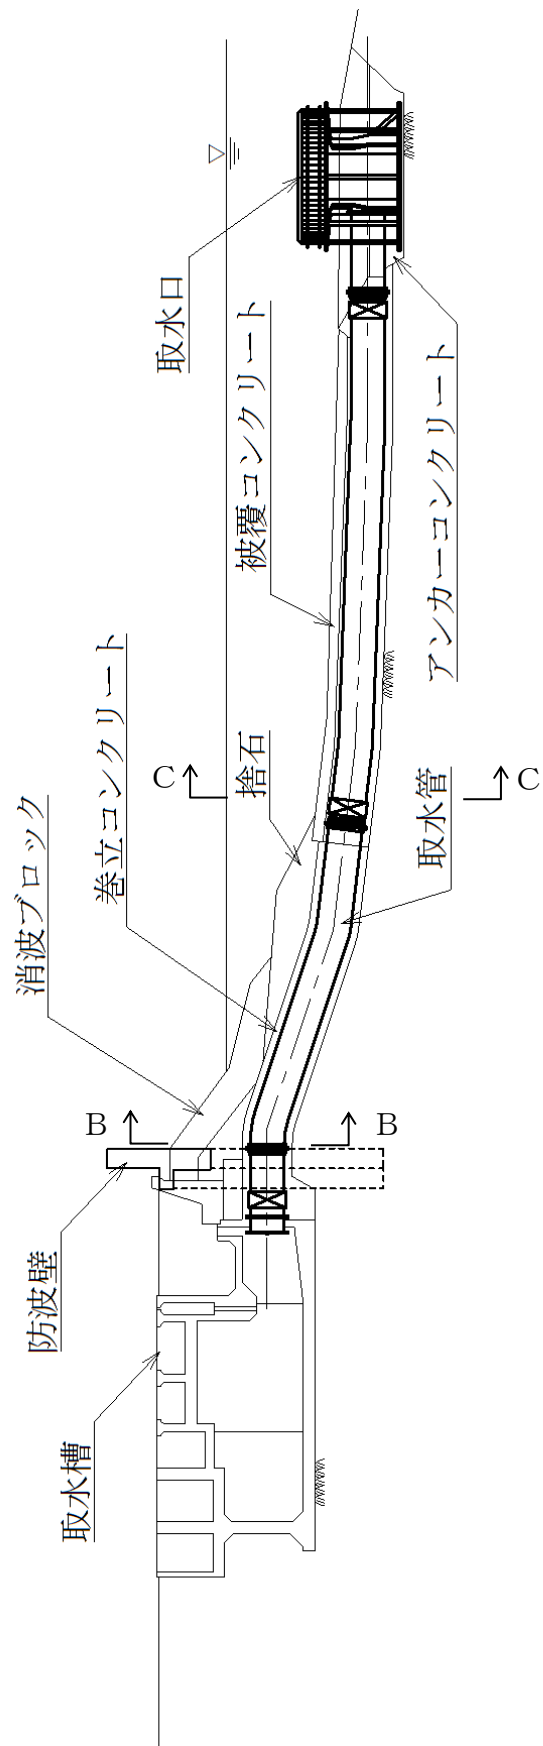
(1) 取水管 断面図 (A-A 断面)
